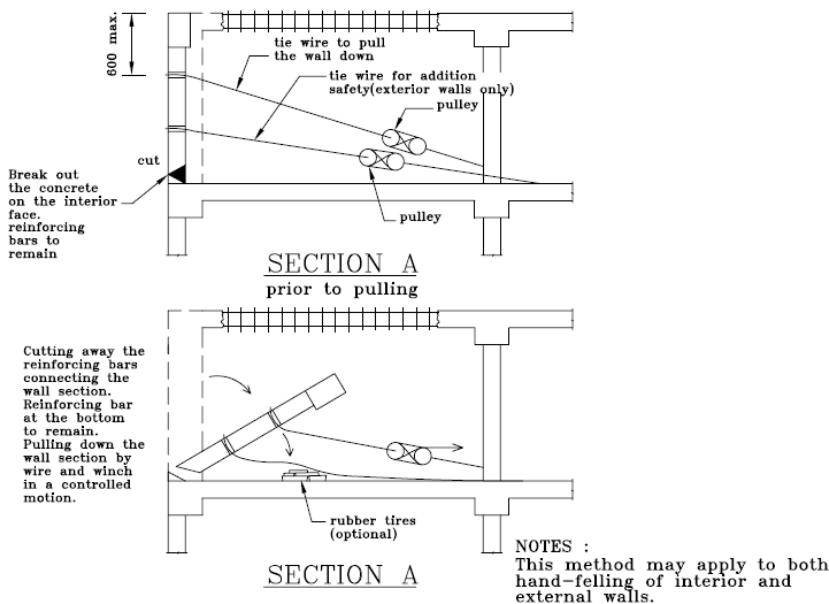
Rrezimi i një muri betonarme (metoda manuale)
